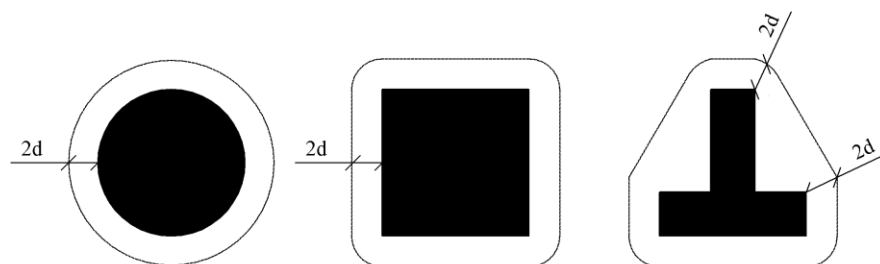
Контрольный периметр для площадей приложения нагрузки, удаленных от свободных краев плиты и отверстия
